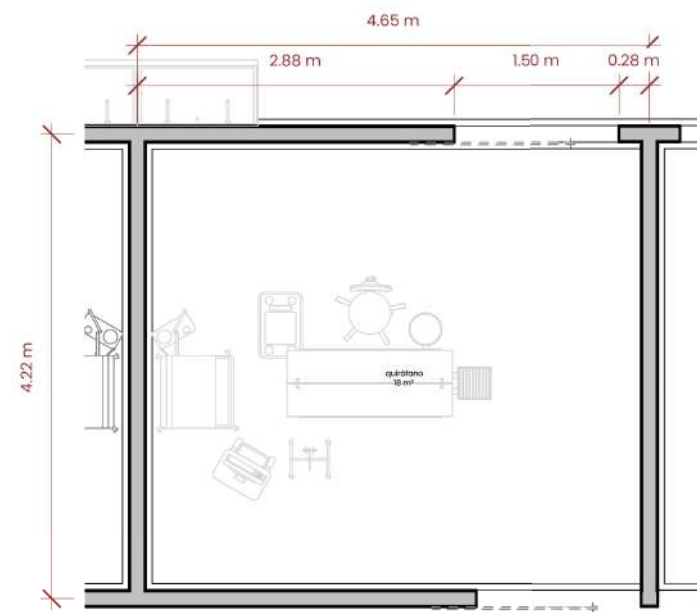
Detalle quirófano. Fuente: Elaboración propia
